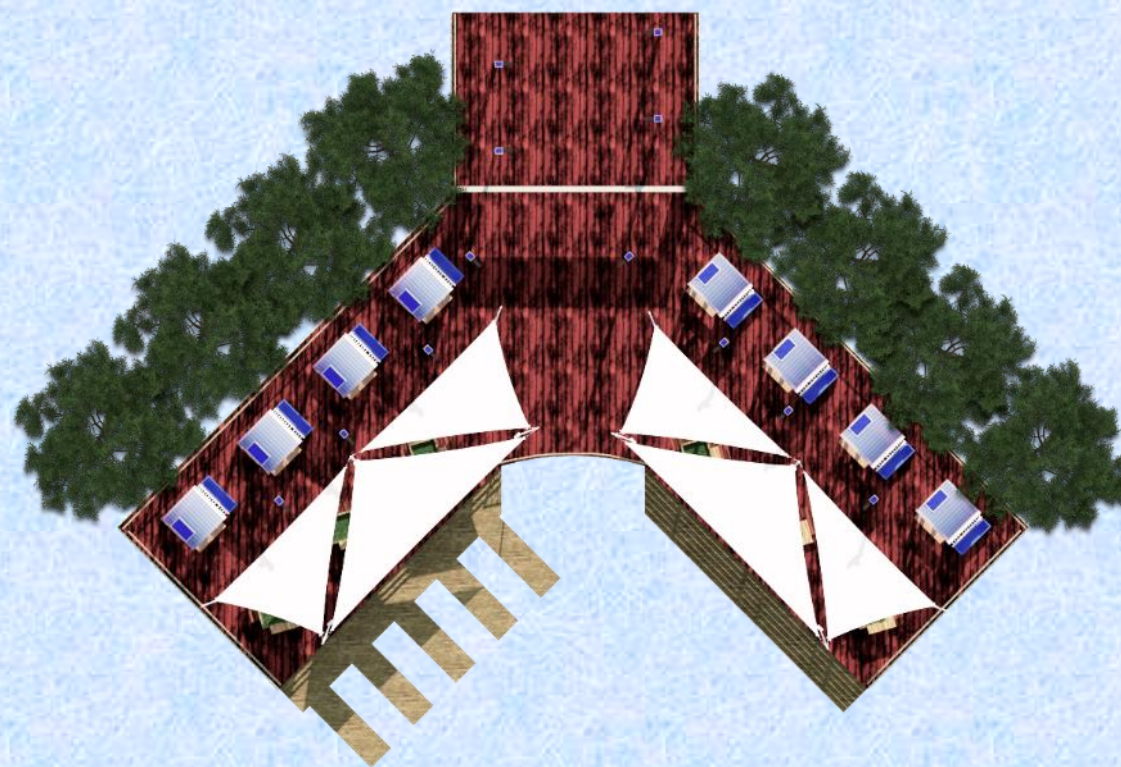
Implantación y planta Plataforma 2. Fuente: Elaboración propia
